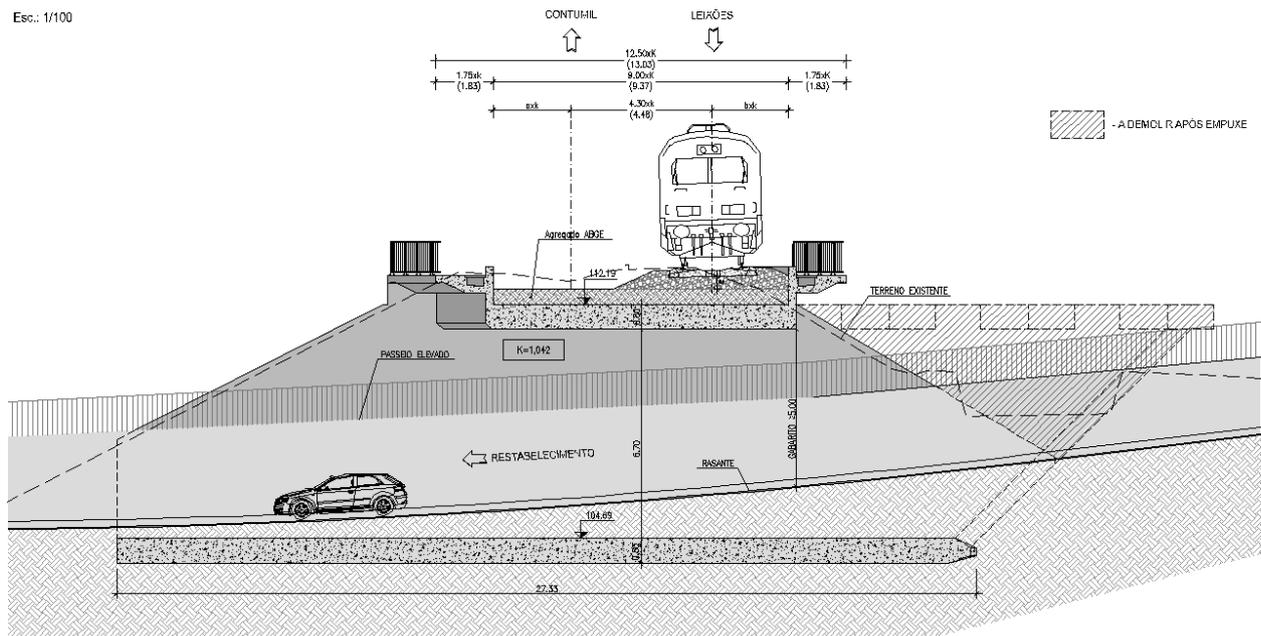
Corte Longitudinal da PIR da Levadinha
